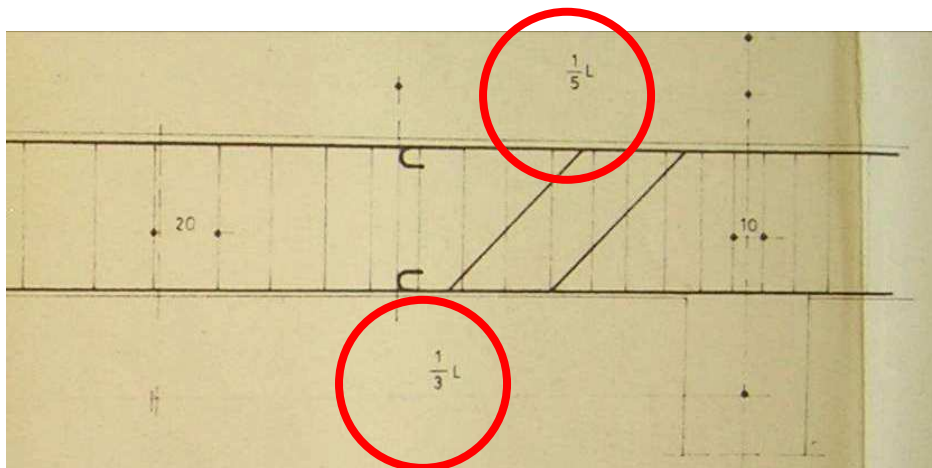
Detalle de las longitudes y anclaje de barras. Edificio 186A.009, 1968
